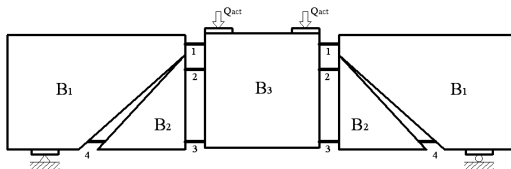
Физическая модель железобетонного элемента без поперечной арматуры, работающего на восприятие поперечных сил
